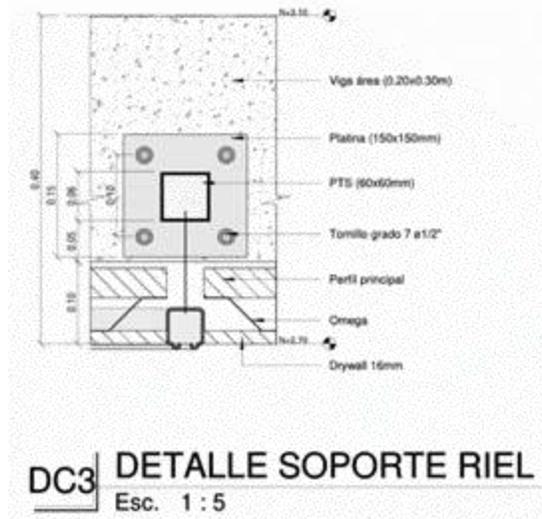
Detalle constructivo de planteamiento de PTS para soporte de riel de movilidad para personas con discapacidad física. Elaboración propia.
